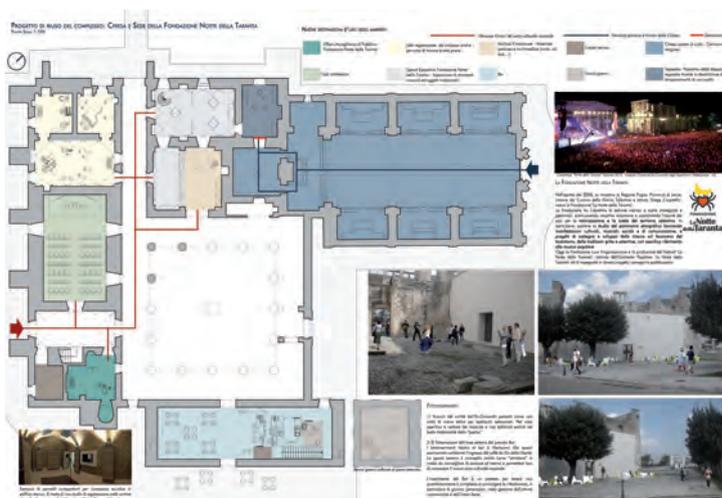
Progetto di riuso del complesso architettonico: pianta delle destinazioni d'uso
